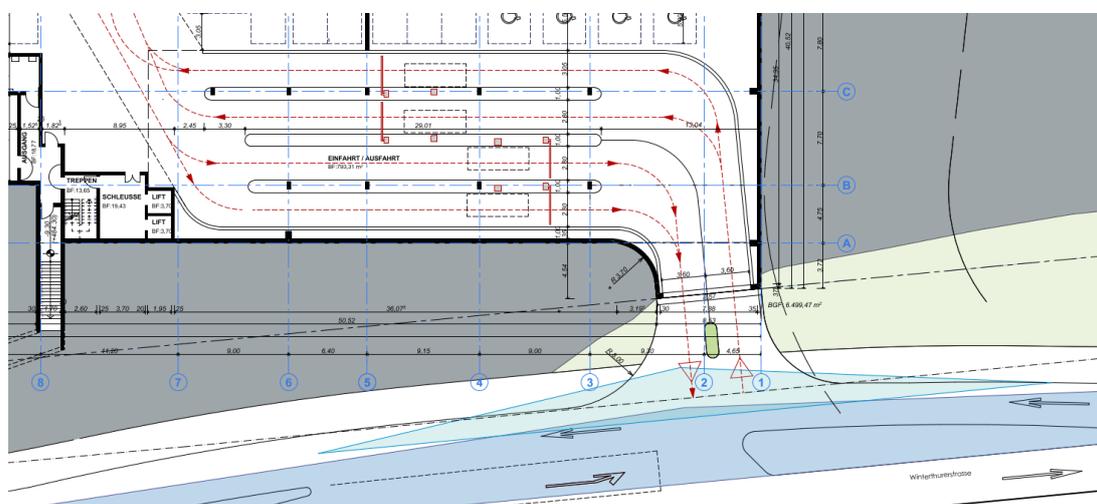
Ausschnitt Parkhaus (Architekt: monoplan, Stand 09.02.2023)
